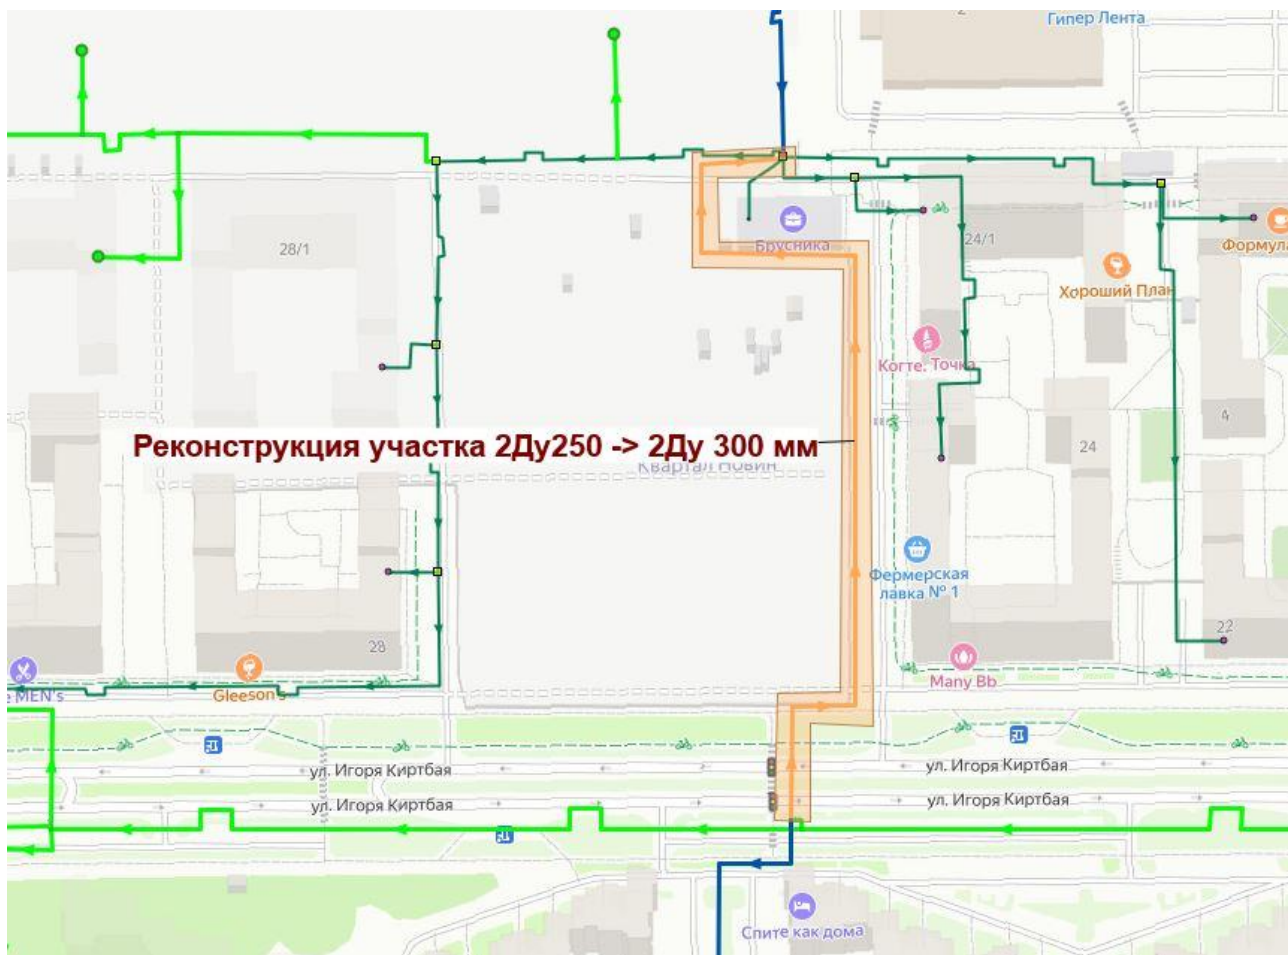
Схема расположения реконструируемого участка от перемычки до УТ-1
